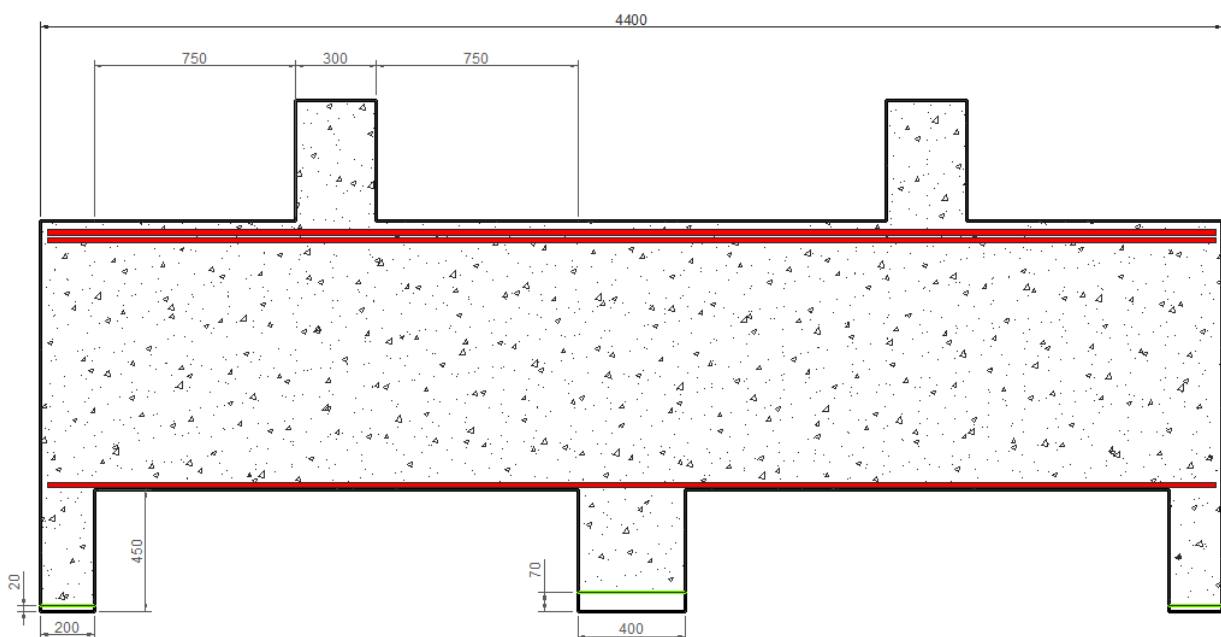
Viga V5 – dimensões em milímetros (mm) – adaptado de Rogowsky *et al.* (1983).
